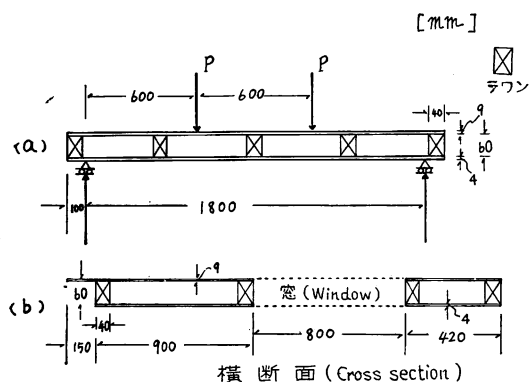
壁パネルの断面構成、寸法および曲げ試験方法
